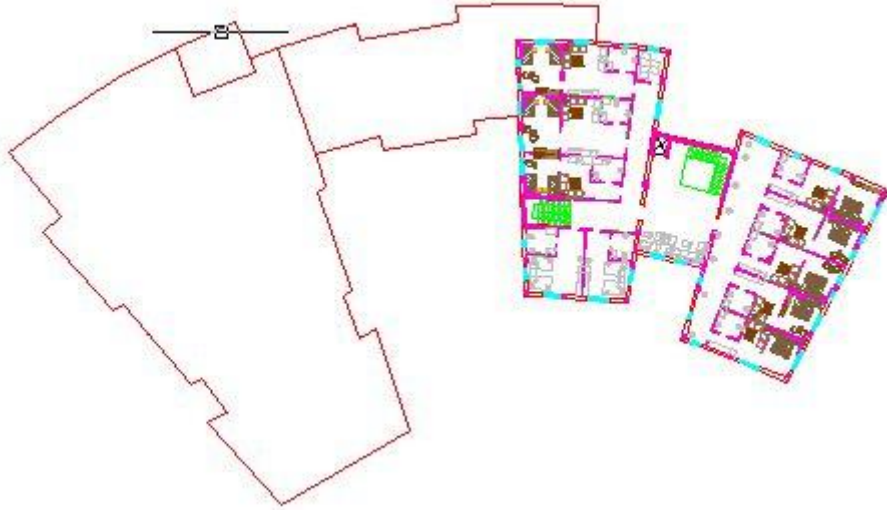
مخطط الطابق الثاني للفندق السكني والمسرح.
